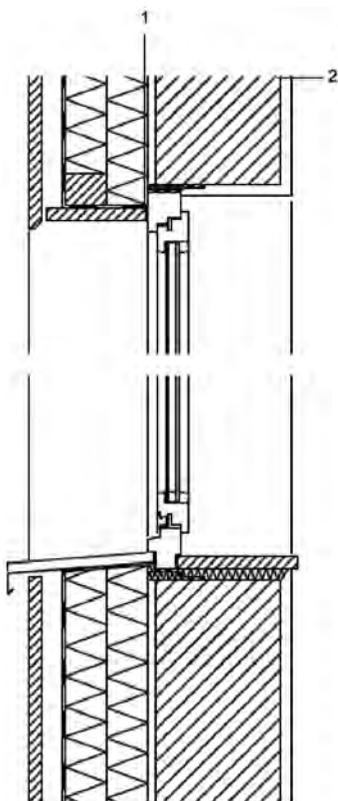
Стык окна с наружной стеной, защищенной навесной вентилируемой фасадной системой (вертикальный разрез): 1 — предварительно сжатая уплотняющая лента; 2 — наружная стена (снаружи внутрь): деревянная обшивка или плитный материал, контр-обрешетка 2/10, диффузионно-проницаемая мембрана Tyvek (наклеивается на комбинированные оконные рамы), двухслойная теплоизоляция (толщина слоя 6 см) на решетчатой опорной конструкции 4/6, наружные кромки окна заподлицо с кладкой, имеющаяся стена (каменная или кирпичная кладка)
